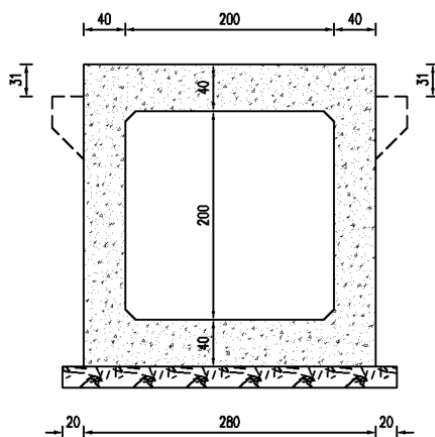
拟建 K2+581 涵洞断面示意图
